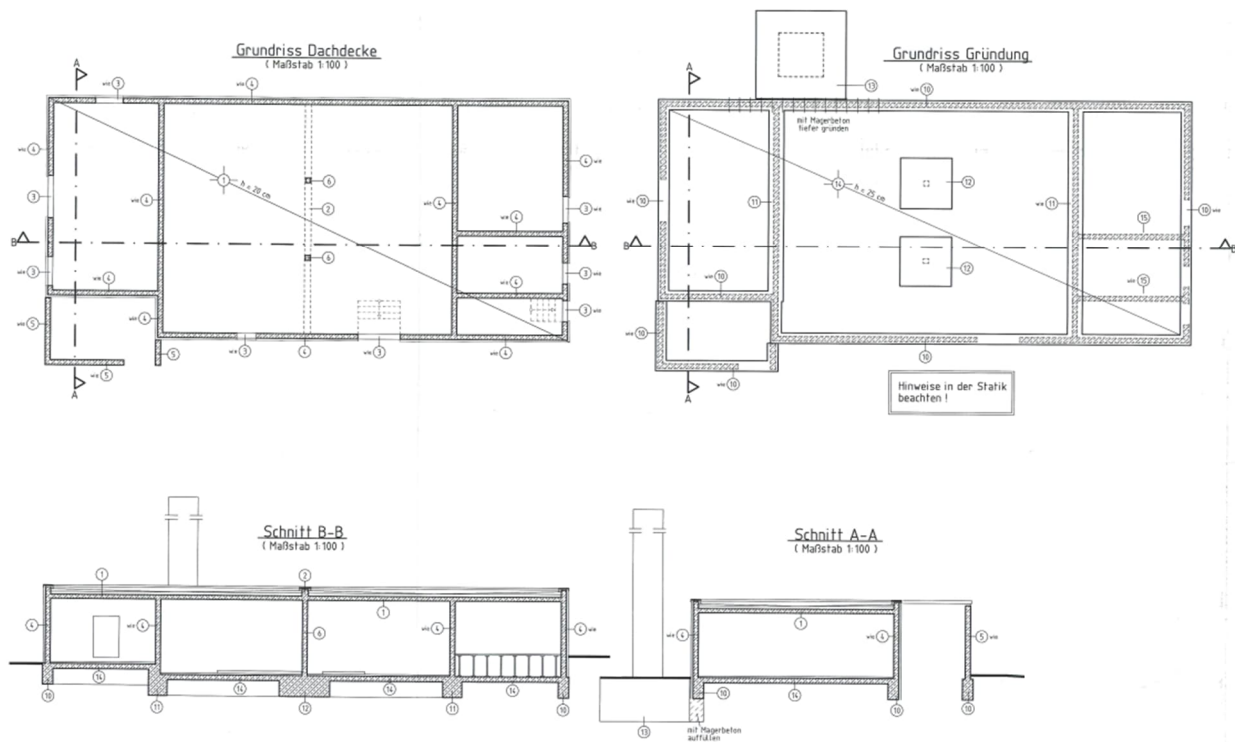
Positionsplan Grundrisse / Schnitte P1a Bauteil K
